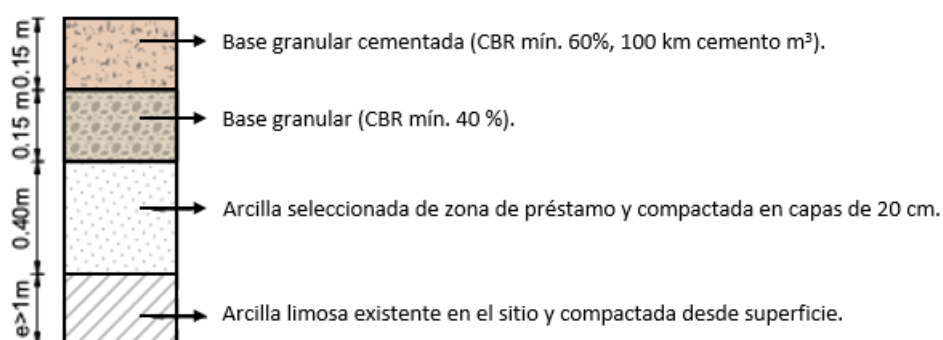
Paquete de relleno en cancha de compostaje para impermeabilización y rodadura.
